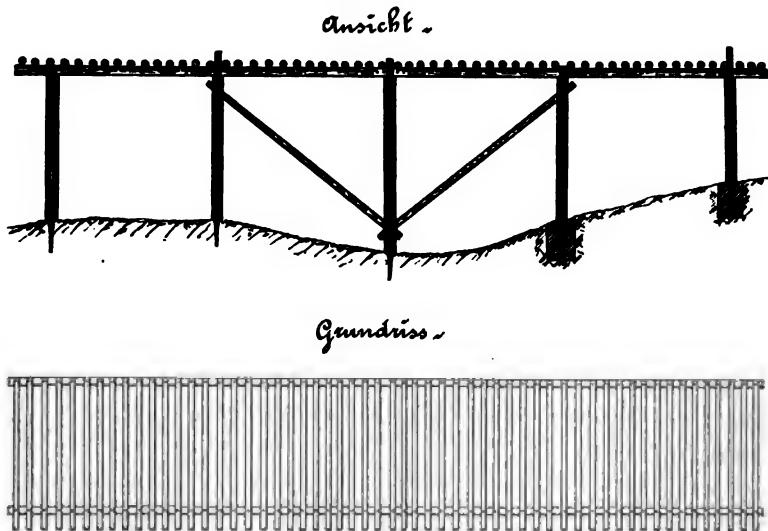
a. Schneebrücke mit Schienenständern. Ansicht und Grundriß. Maßstab 1:200.
